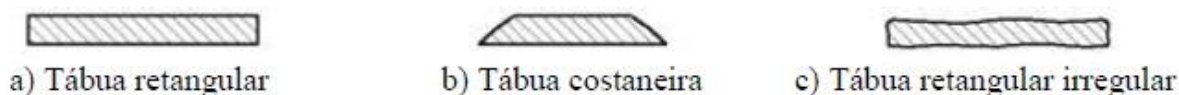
Exemplos de secções transversais das tábuas verticais [8]
